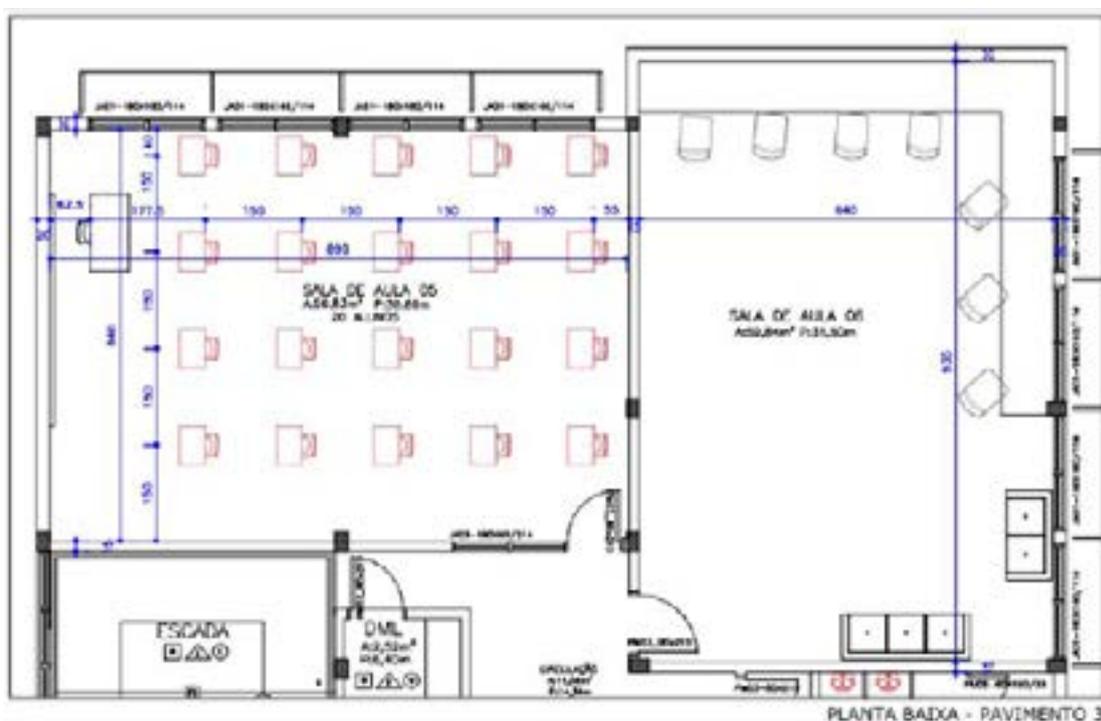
c: Planta baixa segundo pavimento com distribuição das classes e cadeiras mantendo o distanciamento de 1,5m.
